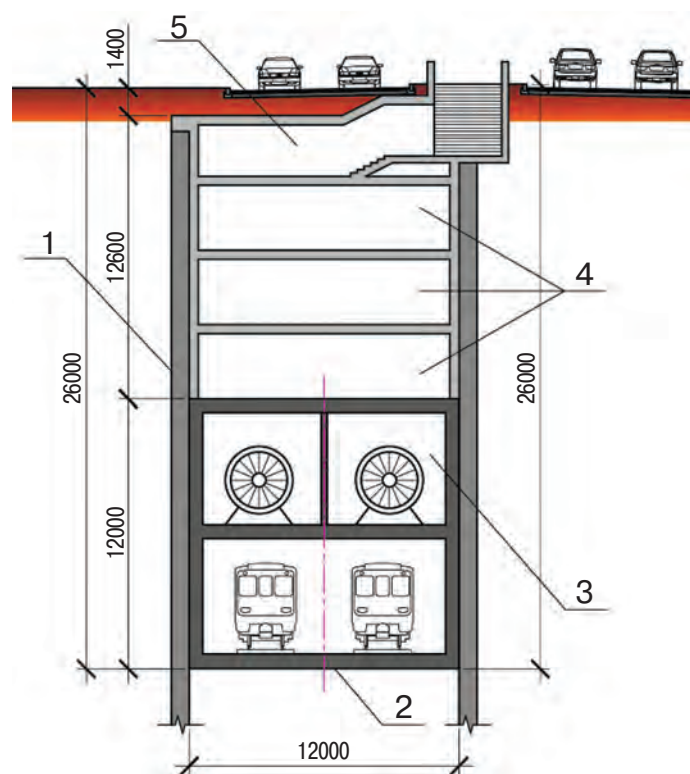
Поперечное сечение участка тоннеля: 1 — ограждающая конструкция; 2 — конструкция тоннеля метрополитена; 3 — вентиляционная установка; 4 — помещения архива; 5 — аварийный выход из метро
